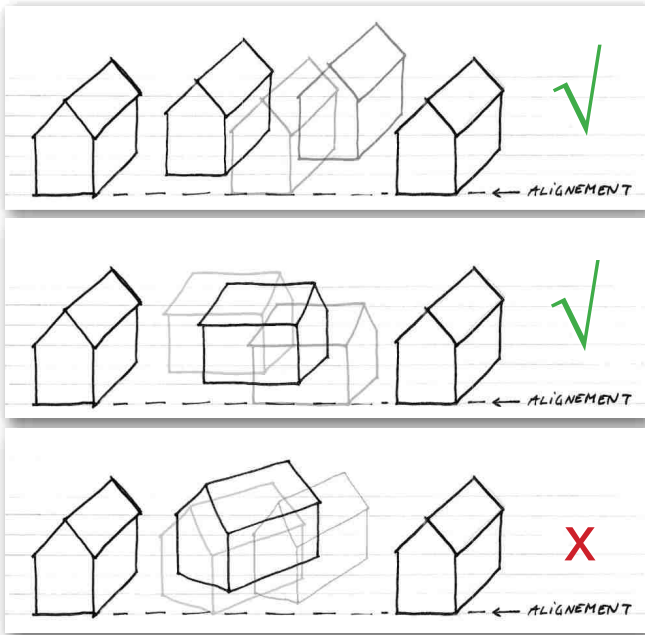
/ Implantation d'une nouvelle construction en fonction des faitages des constructions existantes: parallèle, perpendiculaire ou oblique.
